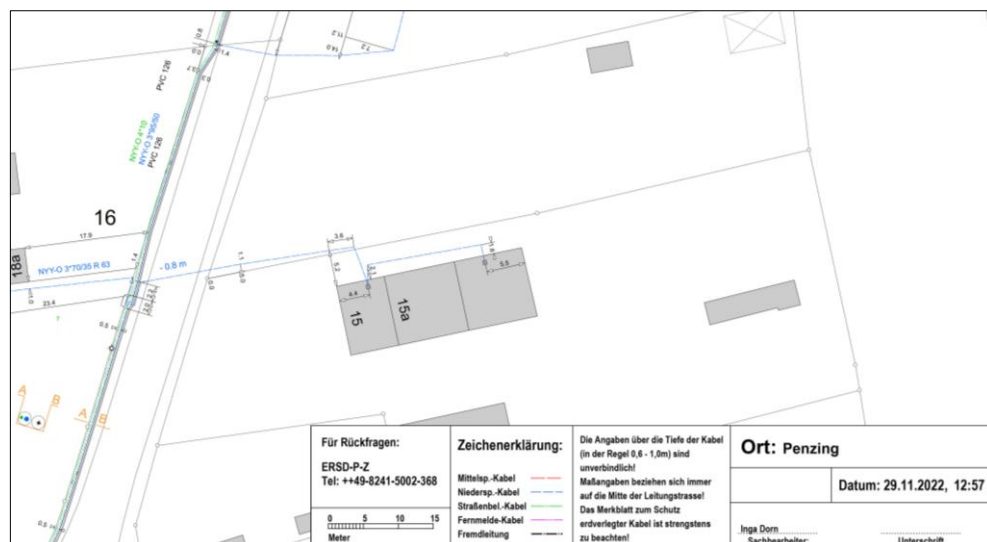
Auszug Kabellageplan, © LEW Verteilnetz GmbH
